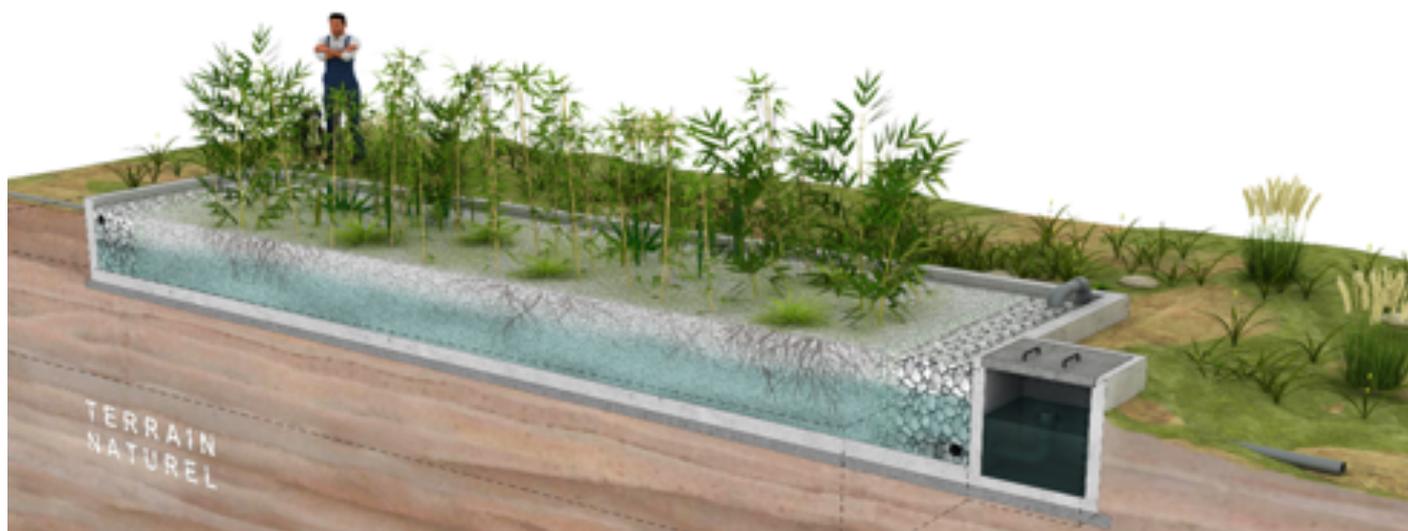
Coupe longitudinale d'un filtre planté horizontal à gravier.
